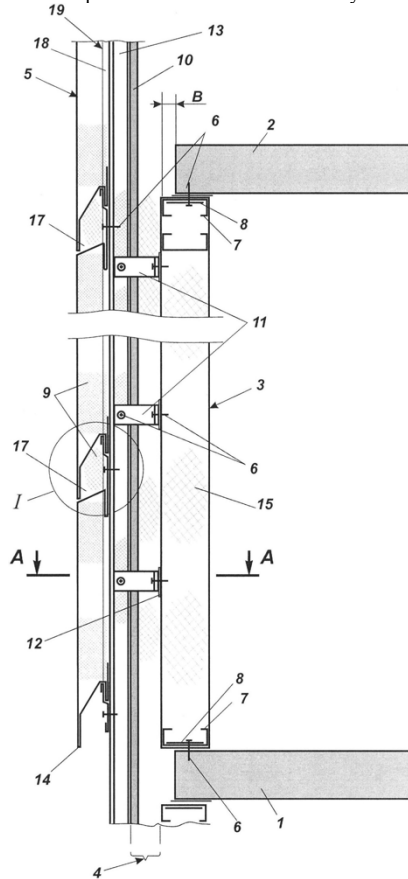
Структура фасадной системы здания на фрагменте вертикального разреза здания [4; 5, с. 62], где: 1 и 2 – плиты перекрытия; 3 – внутренний слой; 4 – фасадный слой; 5 – облицовочный слой; 6 – элемент крепления; 7 – горизонтальный пояс; 8 – пластины усиления; 9 – утеплитель; 10 – плита; 11 – установочные кронштейны; 12 – теплоизоляционная подложка; 13 – лаги Т-образного профиля; 14 – сэндвич-панели; 15 – дополнительные рёбра жёсткости; 17 – потайная ниша; 18 – воздушные каналы; 19 – ступенчатый элемент.
